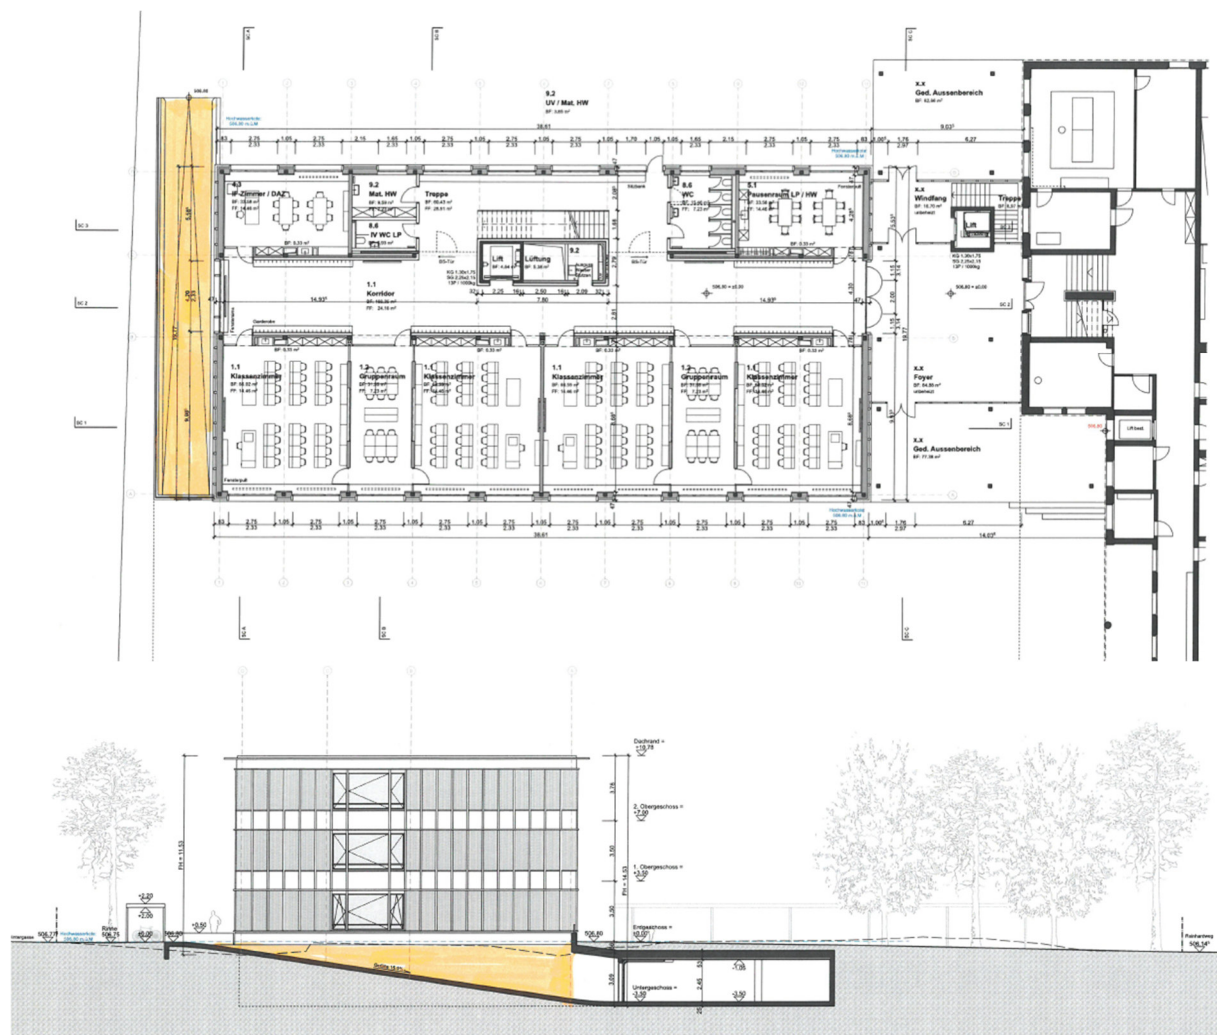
Skizze Rampe: Grundriss EG (oben) und Ansicht Nordwest (unten)
